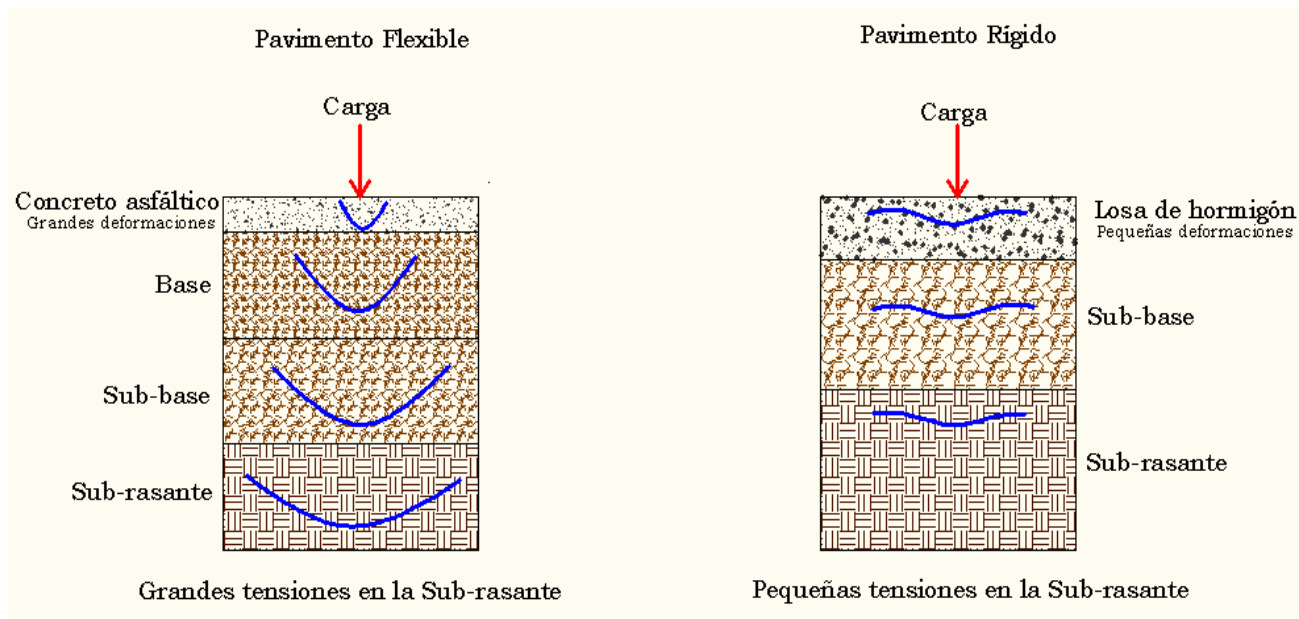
Esquema del Comportamiento de Pavimentos Flexibles y Rígidos.
